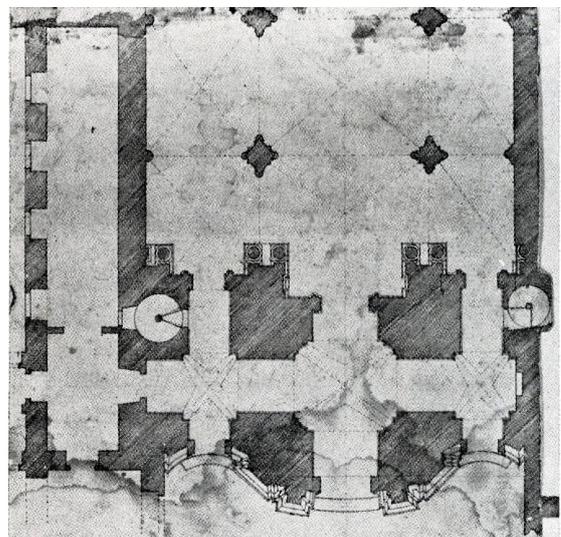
Josef Munggenast, Grundriss der Turmfassade, 1722, StiAZ Plansammlung/IV.
